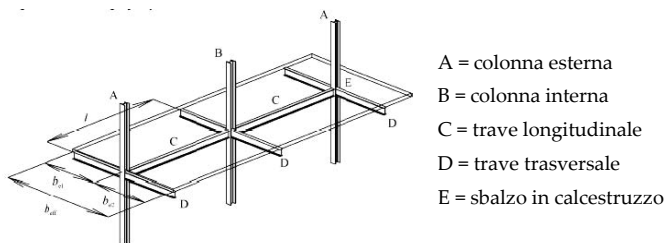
Definizione degli elementi in una struttura intelaiata
